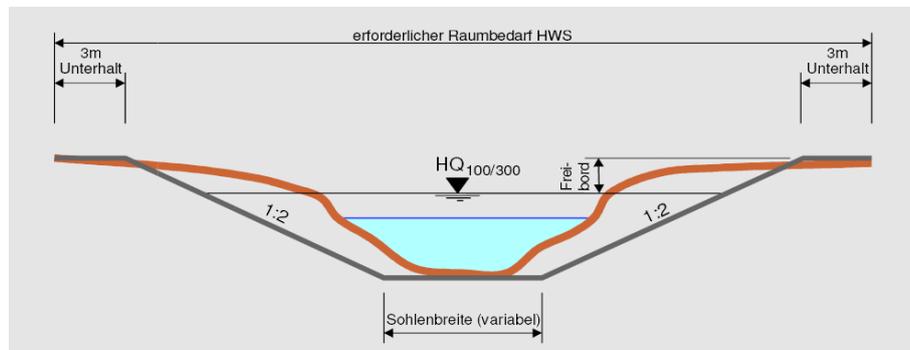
Querprofilbetrachtung für Fließgewässer ohne Damm (gewaesserraum.ch)
